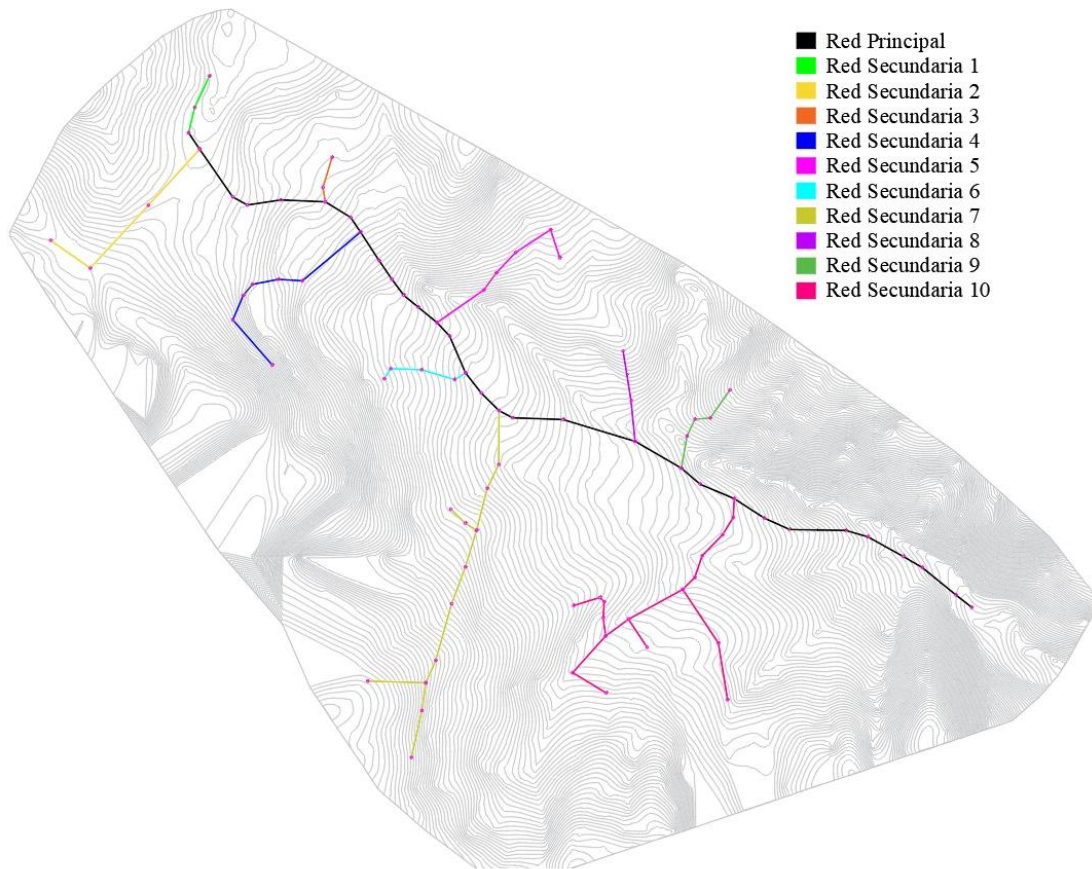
Vista en planta de las redes de alcantarillado
